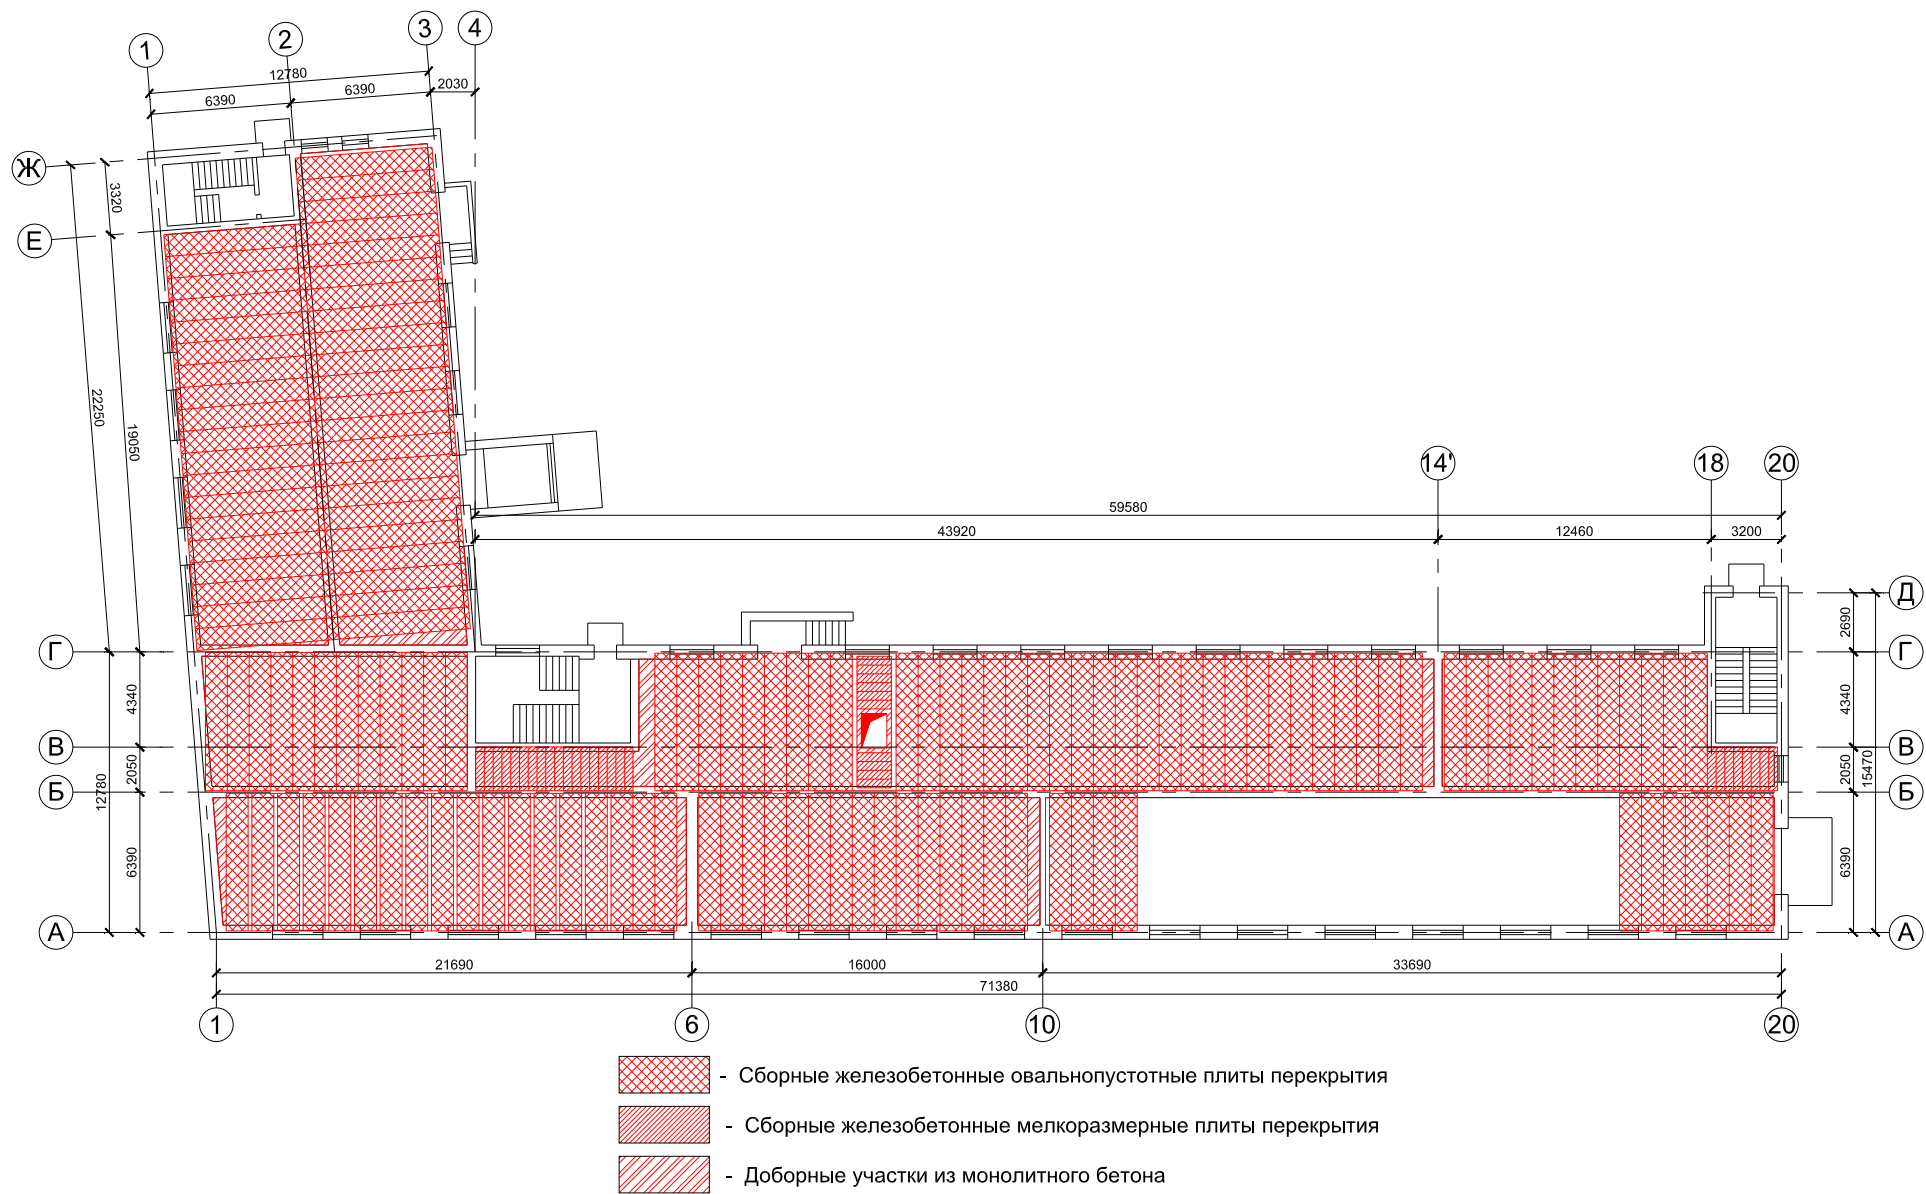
Схема раскладки плит перекрытия над цокольным этажом здания.
